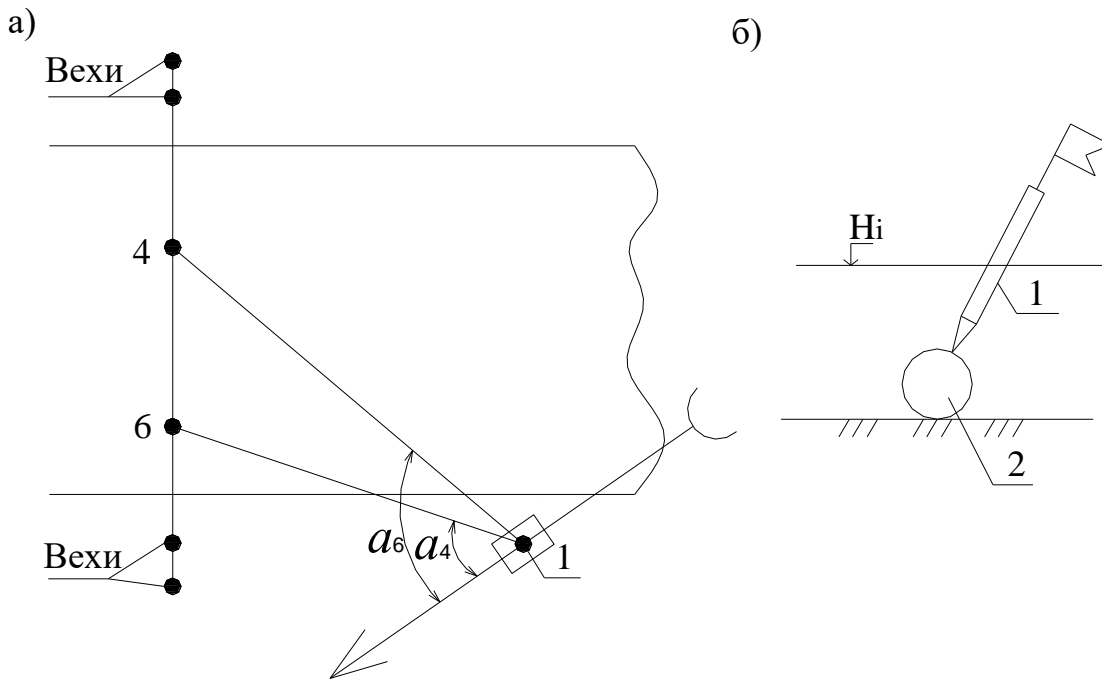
Схема закрепления вертикалей 4 и 6 на гидростворе: а) угловыми засечками; б) плавающими вехами; 1 – веха; 2 – груз
